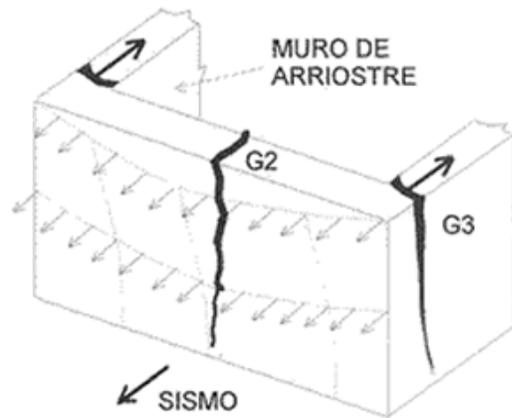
Deformación del Muro por Carga Sísmica Transversal
